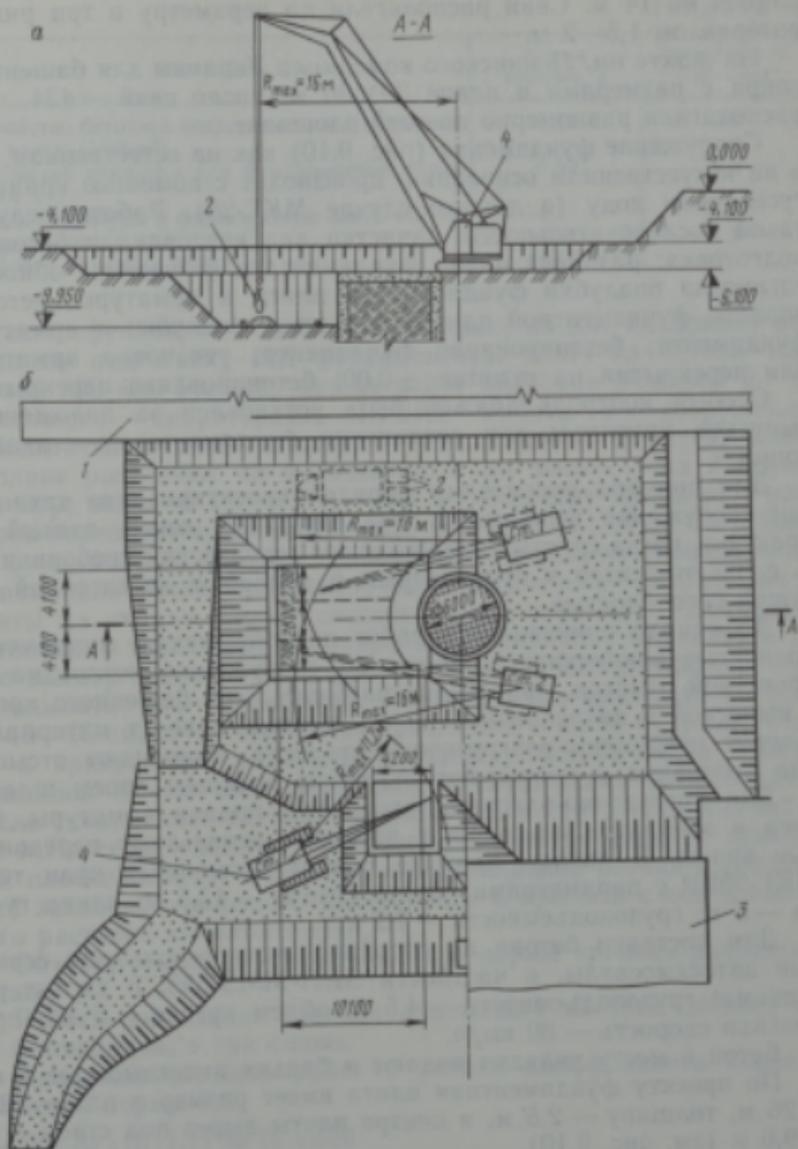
Схема сооружения фундаментной плиты под башенный копер:
